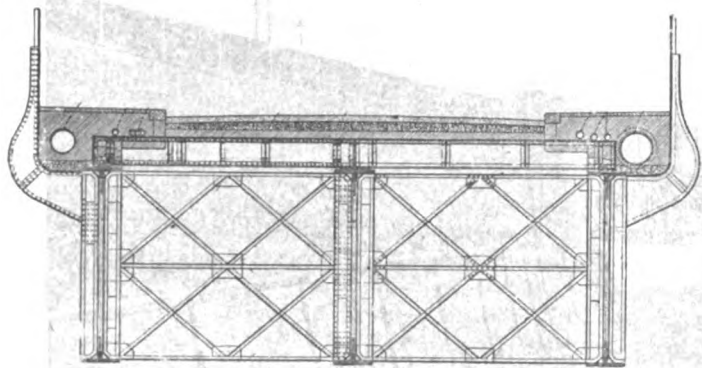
Cavalcavia di Mill Lane - Sezione.
